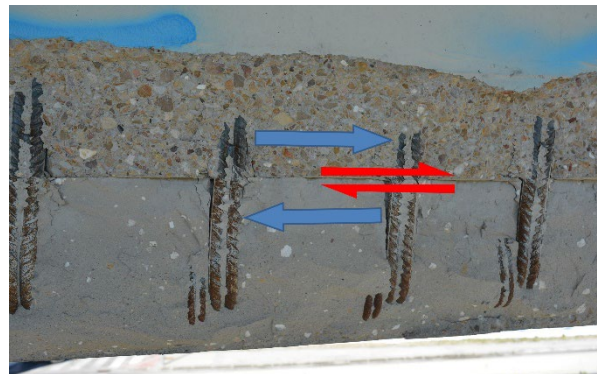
Deslizamiento relativo entre losa inferior (abajo) y alma de la artesa (arriba)
